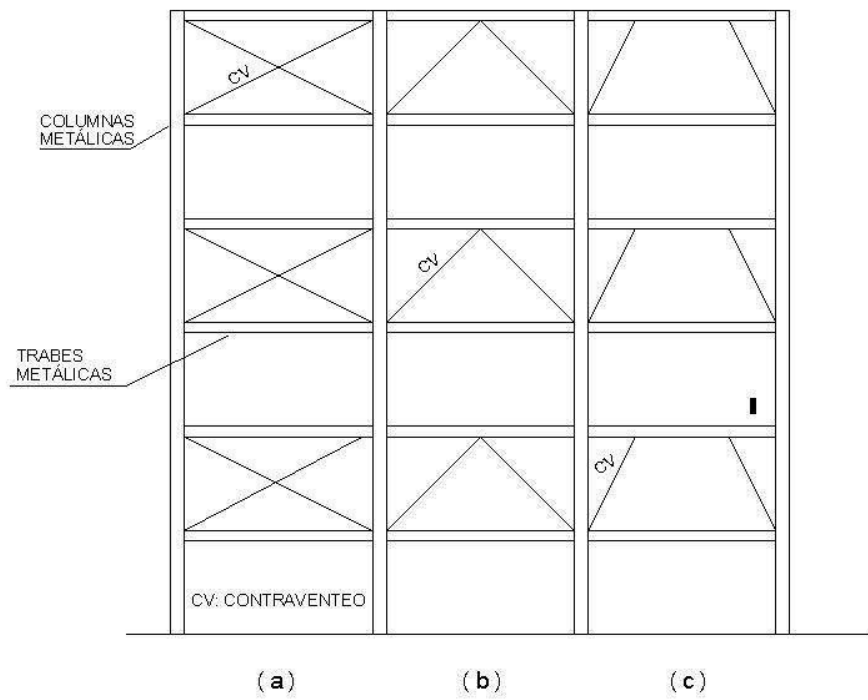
Contraventeos (a) X (b) K (c) Rodilla
